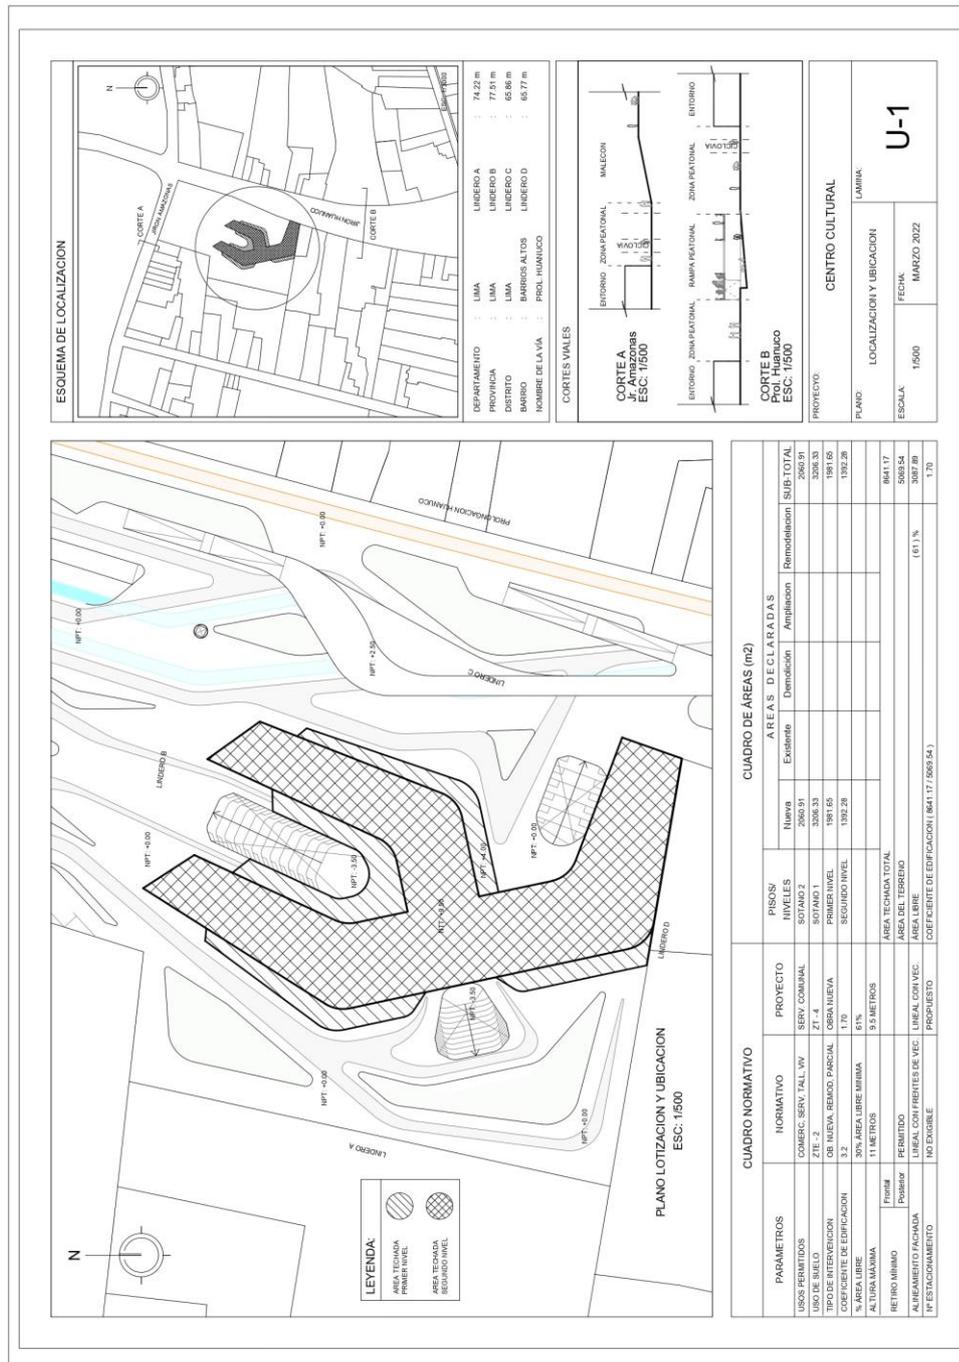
Plano de ubicación y localización del proyecto arquitectónico
